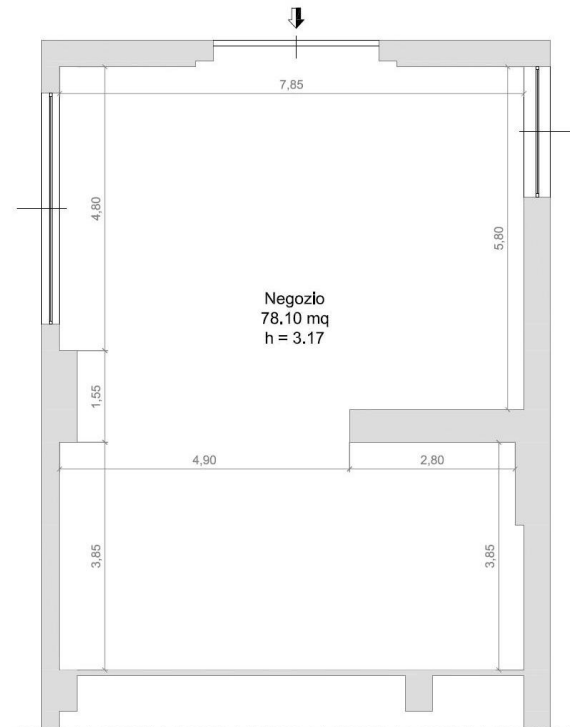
Planimetria Catastale Foglio 46, p.lla 1235, sub 12.
